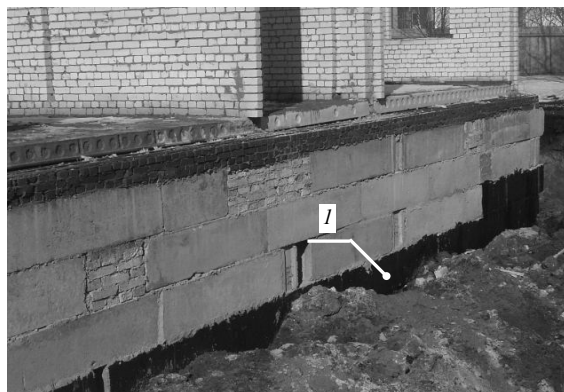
Устройство гидроизоляции стен подвала полимерраствором:
